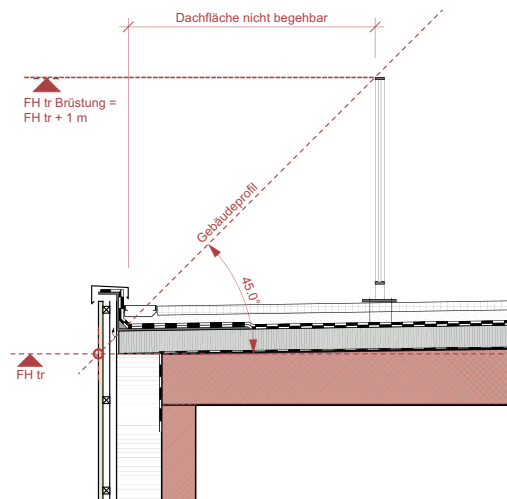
Bei einer innerhalb eines zulässigen Gebäudeprofils liegenden, zurückversetzten Brüstung gilt eine traufseitige Fassadenhöhe "Brüstung", die einen Meter höher ist als die sonst in der jeweiligen Zone zulässige Fh tr.
